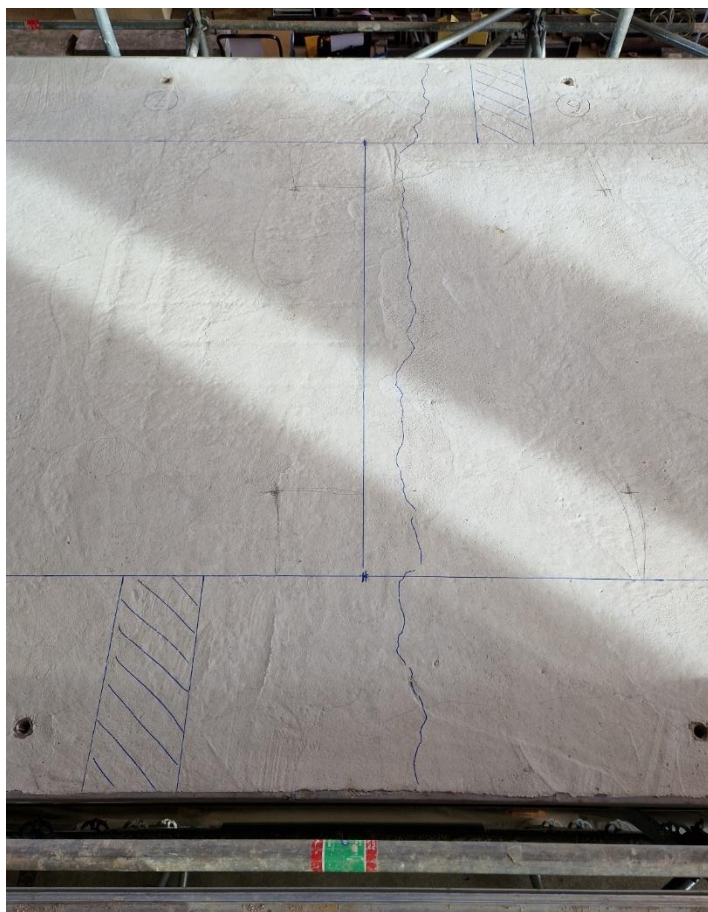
Fissures centrales entre dalles 6 et 7 et fissures est entre dalles 3 et 4
